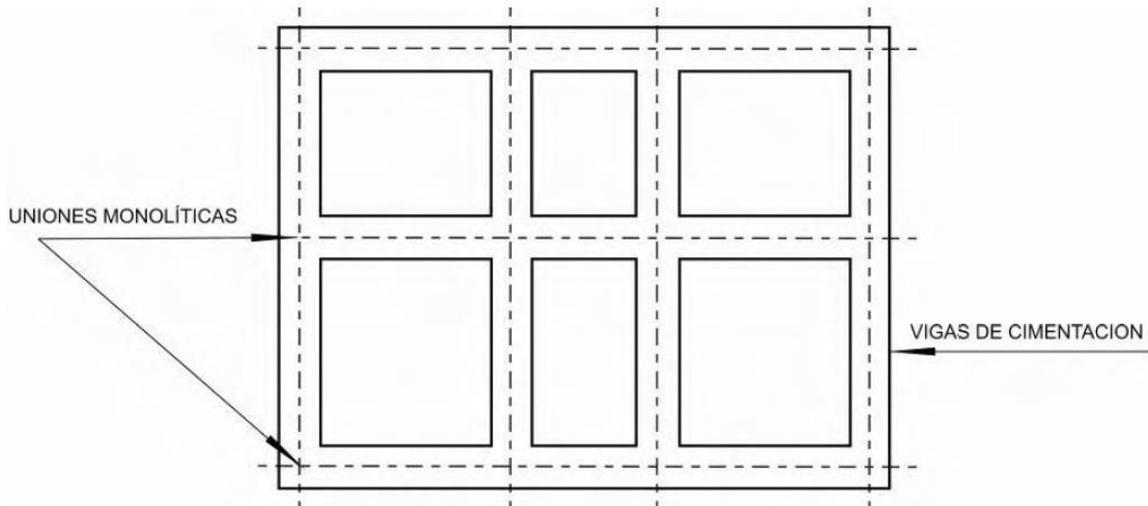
Figura E.2.1-1 Sistema reticular de vigas que configuran anillos cerrados y continuos
